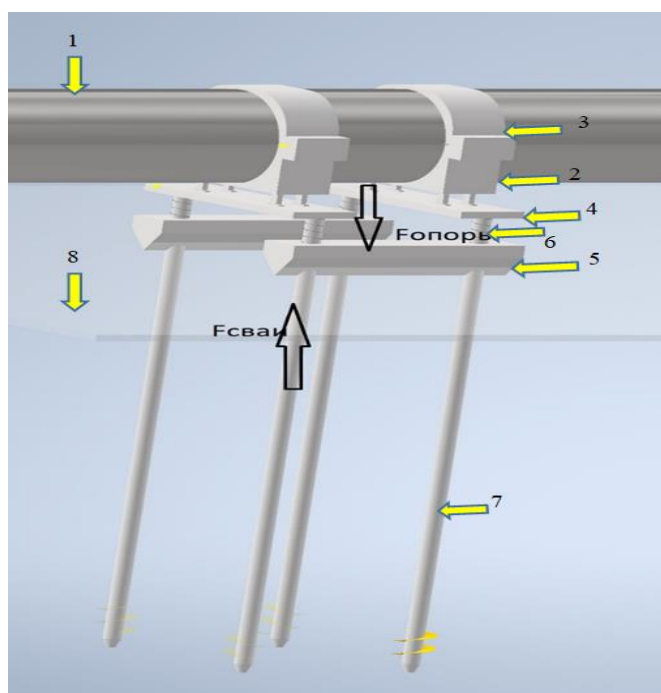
Модель разработанной конструкции опоры надземного магистрального трубопровода: 1 – трубопровод; 2 – ложемент; 3 – полухомут; 4 – стол-ростверк металлический; 5 – плита железобетонная; 6 – демпфер пружинный; 7 – свая; 8 – мерзлый грунт [143]
